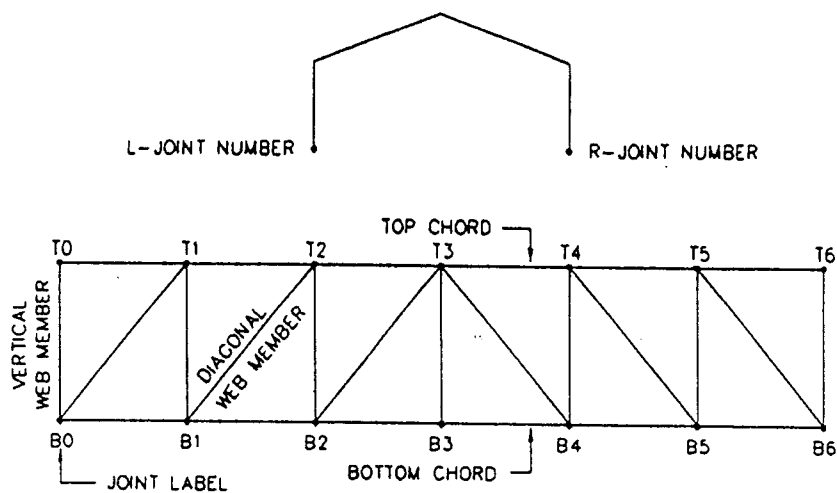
รูปตัวอย่างการใส่ข้อมูลในคำสั่ง WEB MEMBER PATTERN กรณี PITCH ROOF TRUSS
